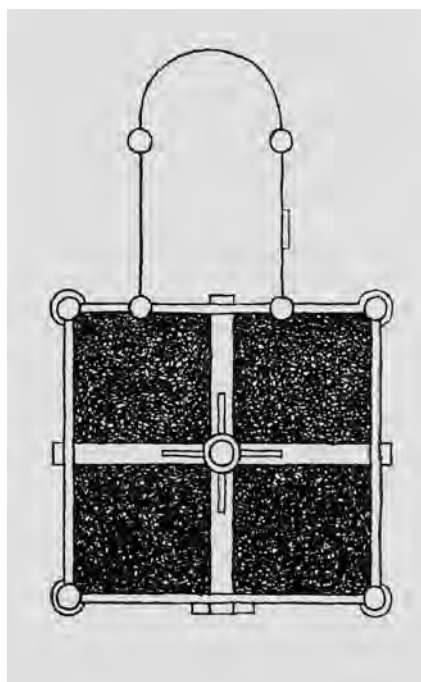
Grundriss einer Einmaststabkirche – aus Dan Lindholm, *Stabkirchen in Norwegen*. Stuttgart 1979.
